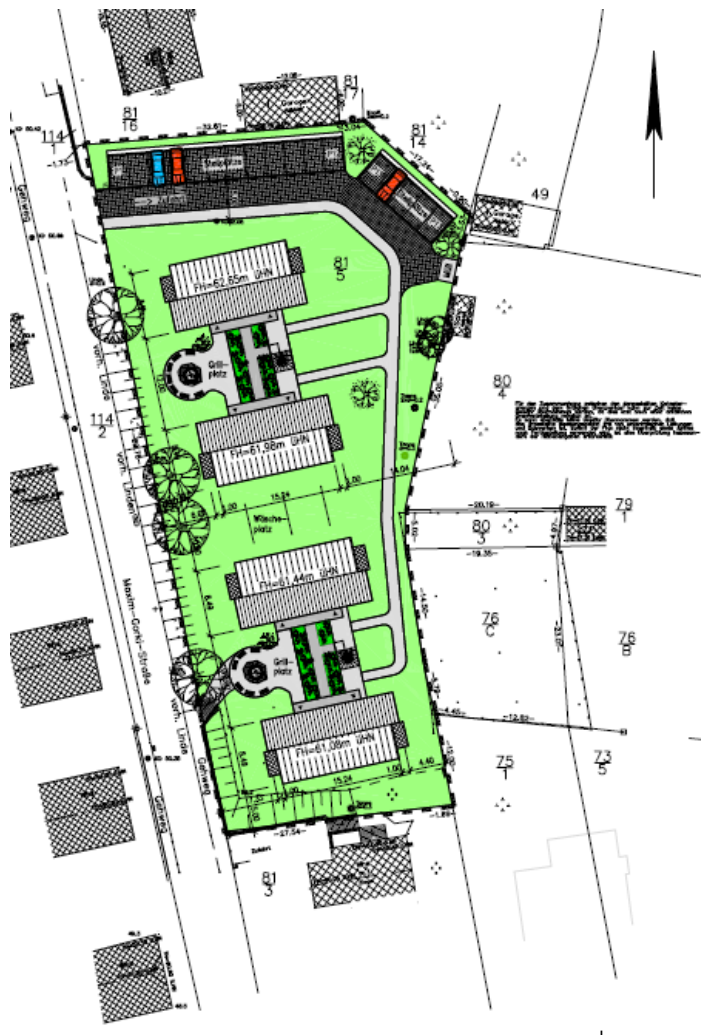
Lageplan vom Ingenieurbüro Rentel (Lageplan vom 22.04.2010)
